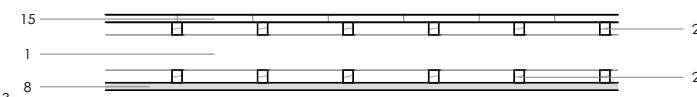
Detalle Constructivo 04. Esc. 1:50
